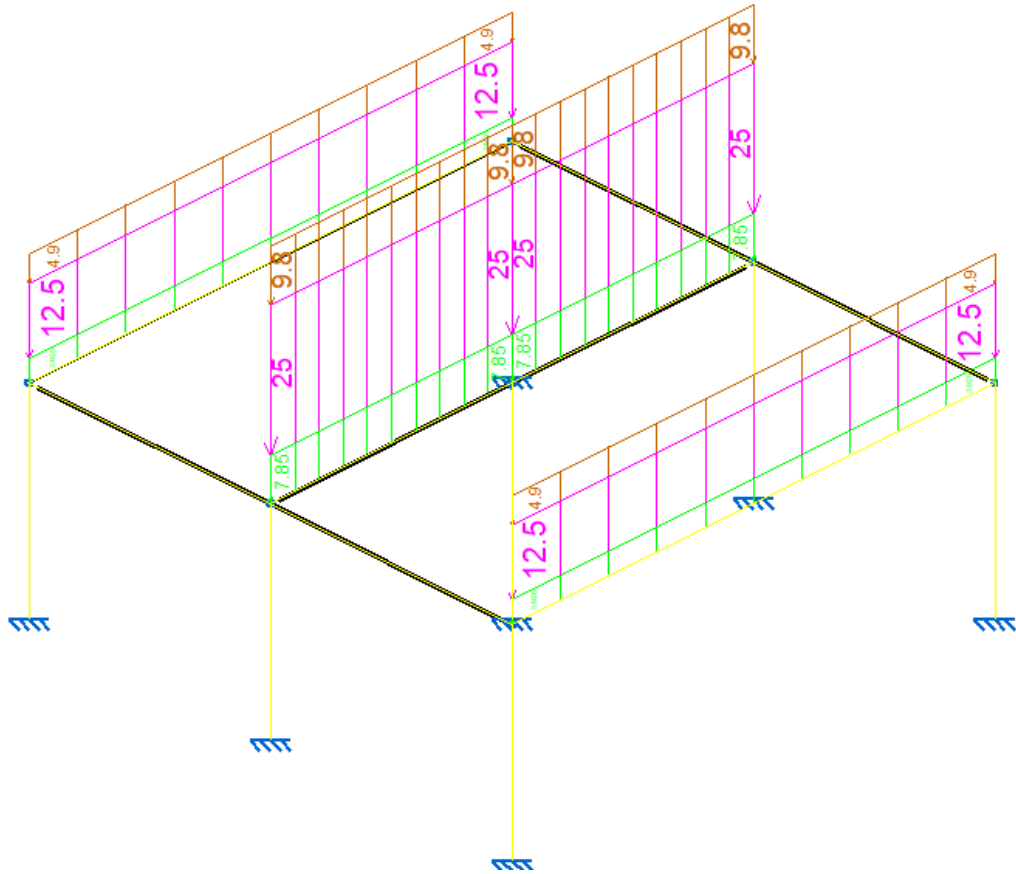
Modelo de cálculo para vigas de entrepiso. Fuente: Elaboración propia
